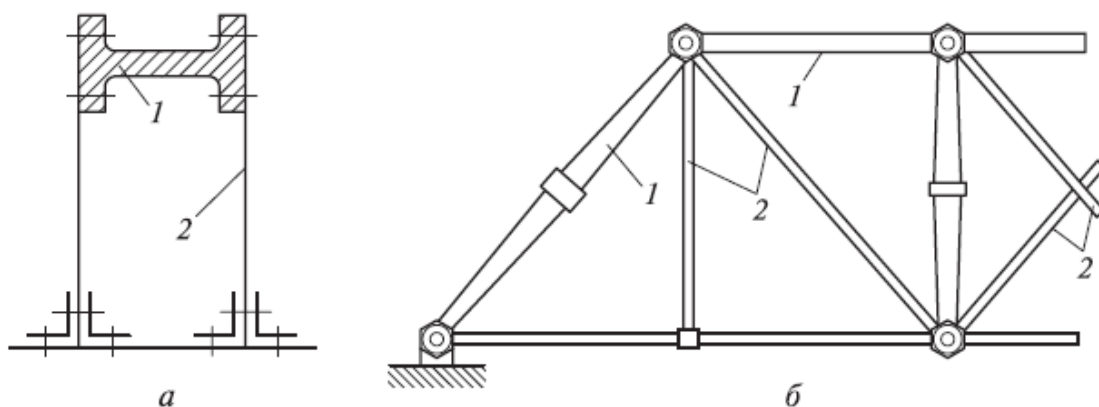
Элементы (а, б) мостов с чугунно-железными несущими конструкциями:
